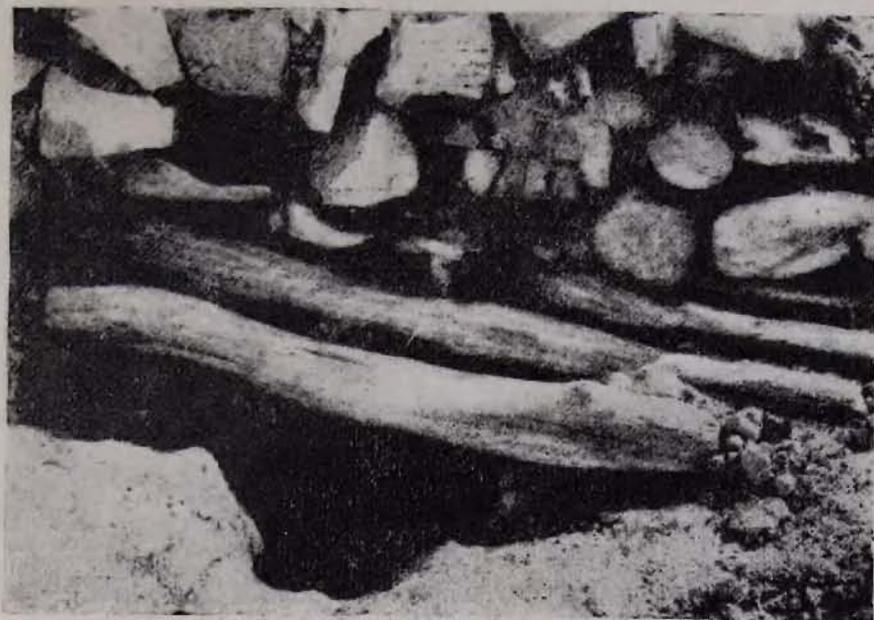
Система перекрытия канала под стеной храма бога Халды
